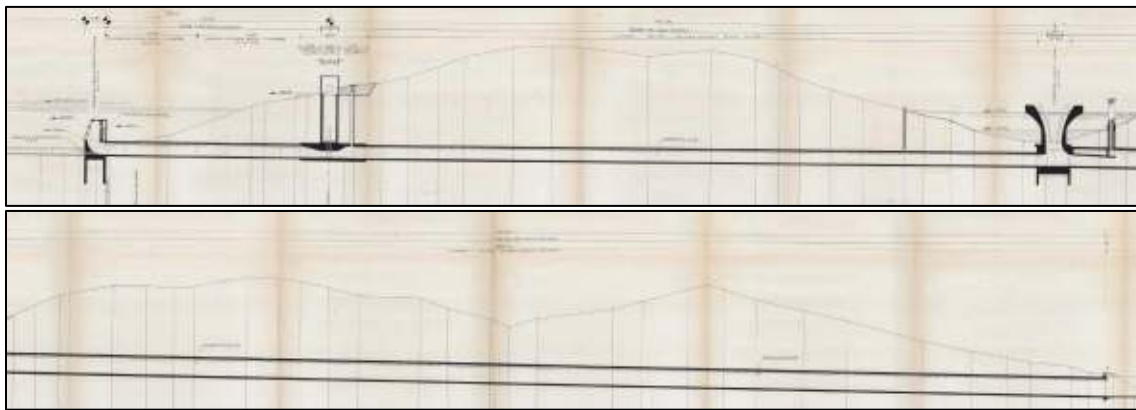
Galleria scarico di fondo – Sezione longitudinale
